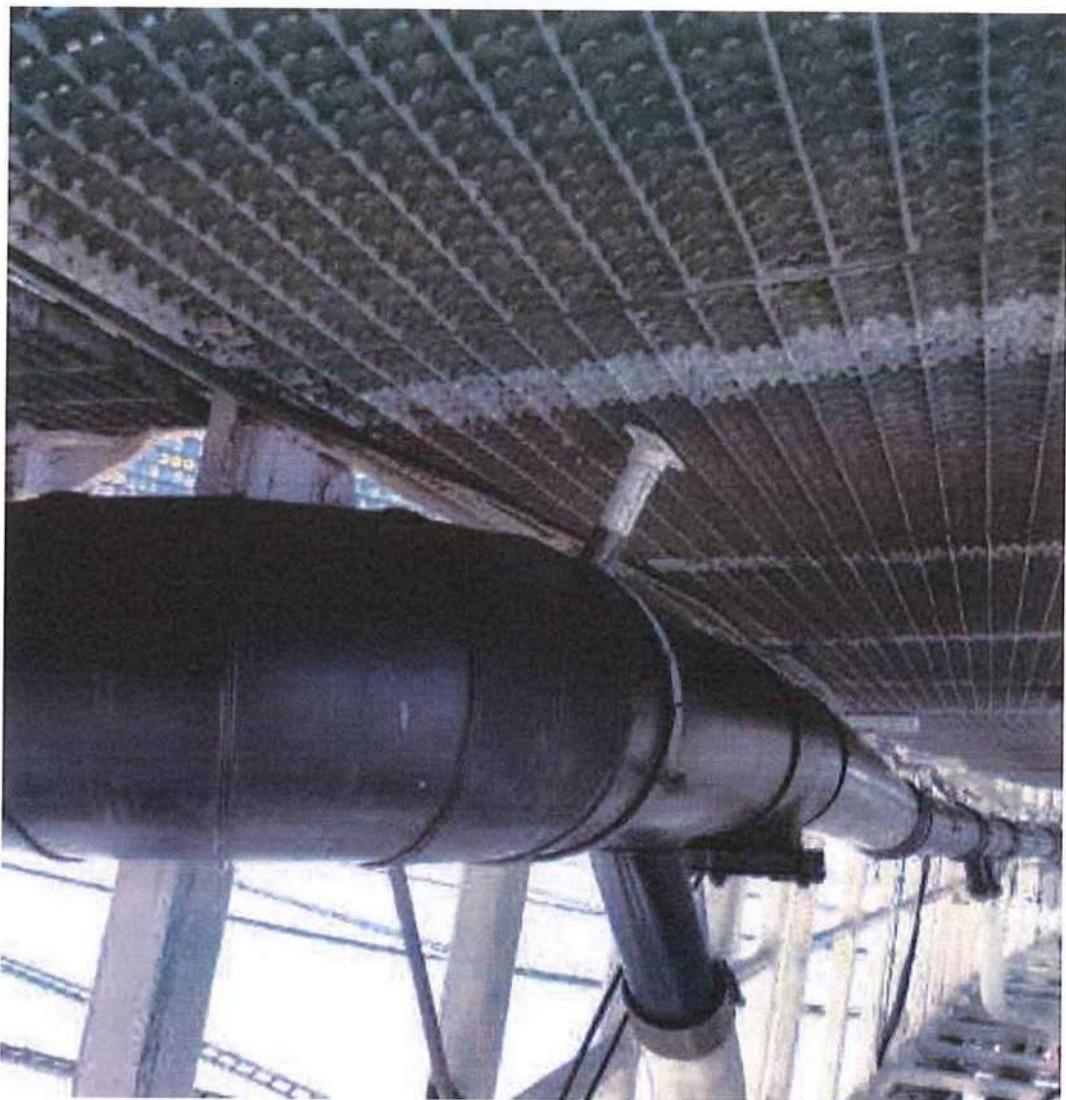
Montagem indevida da braçadeira do suporte da tubulação de drenagem do segmento 50-51
